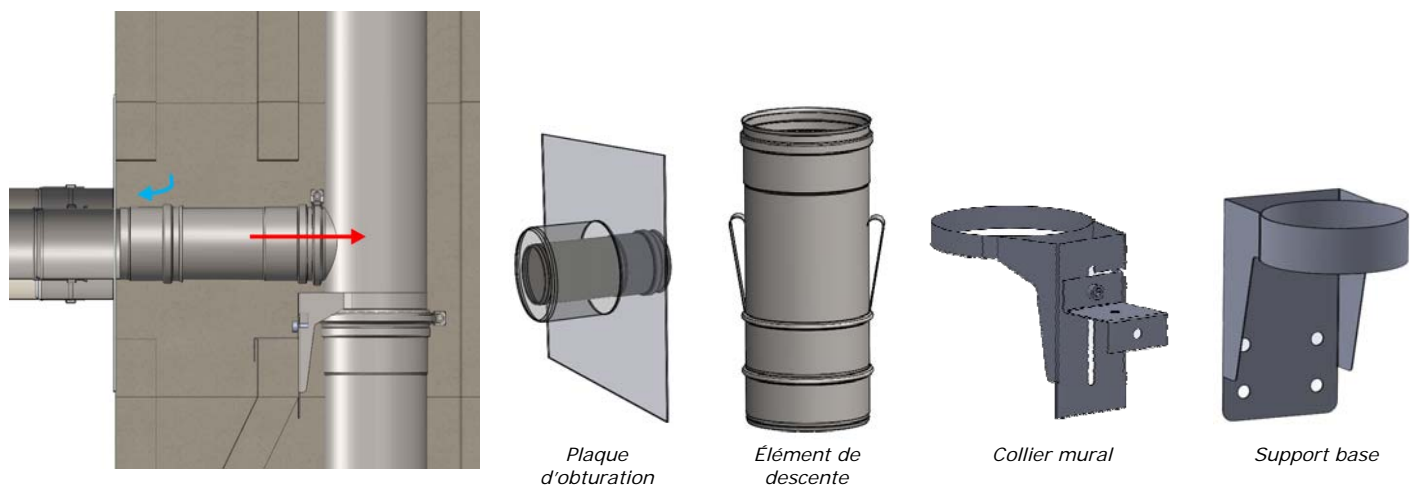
Mise en place du conduit de liaison, version DINAGAS 3CE+ SW pour rénovation dans un conduit existant et accessoires de pose
